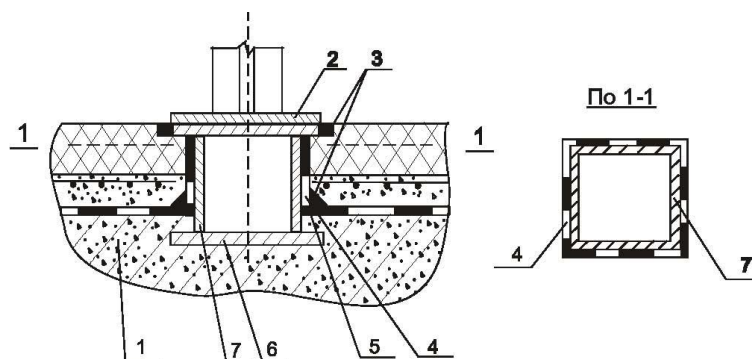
Устройство гидроизоляции в месте расположения стойки ограждения.
